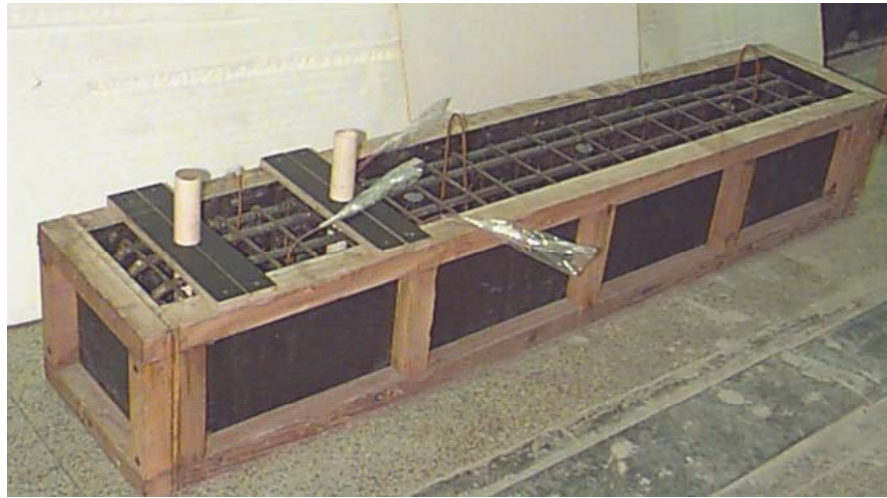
Armadura na fôrma e dispositivo de fixação do tubo de pvc para a execução dos furos.
